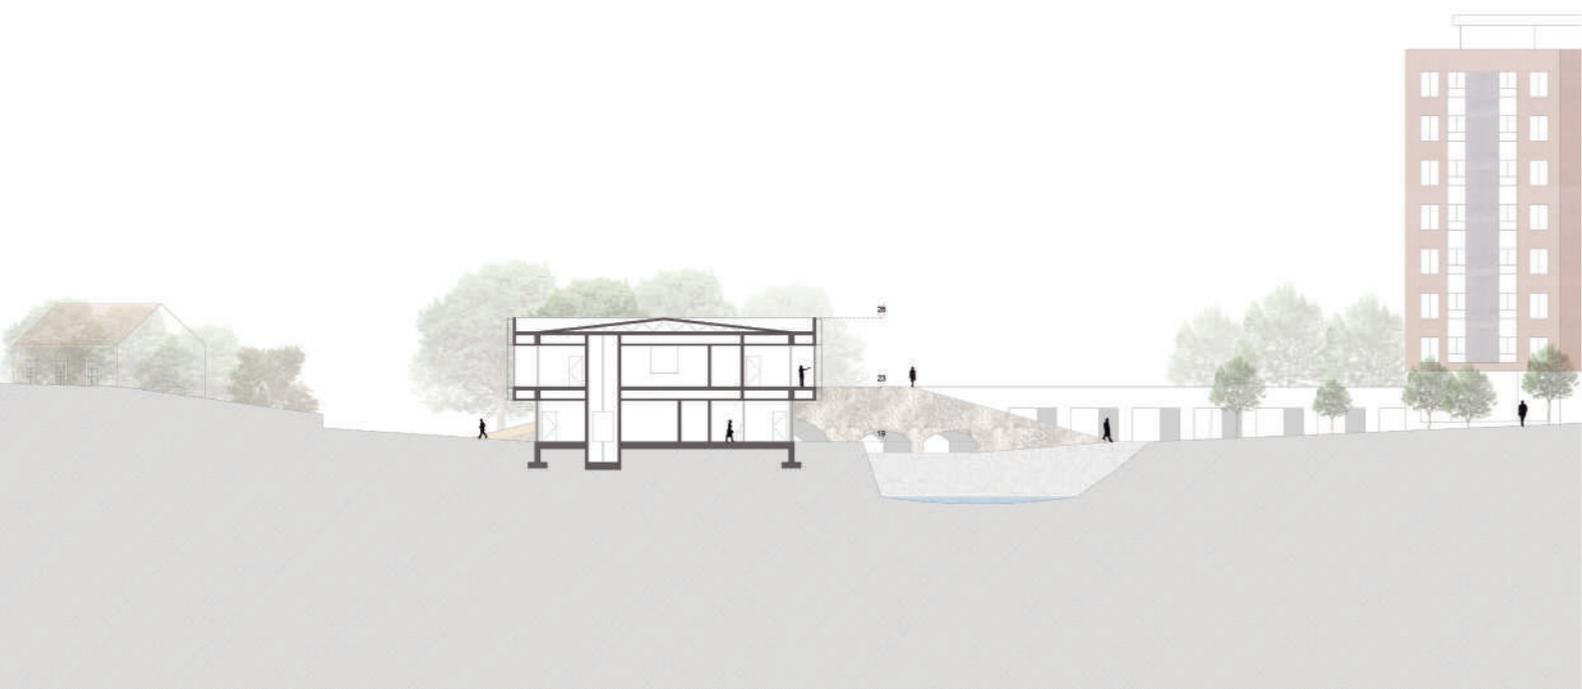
Corte Transversal B-B' (redução da escala 1:200)
